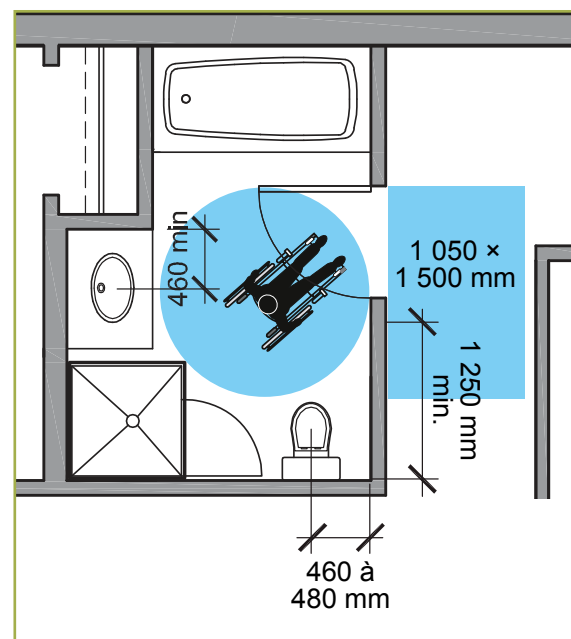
Dégagements dans une salle de toilette dans un logement minimalement accessible
